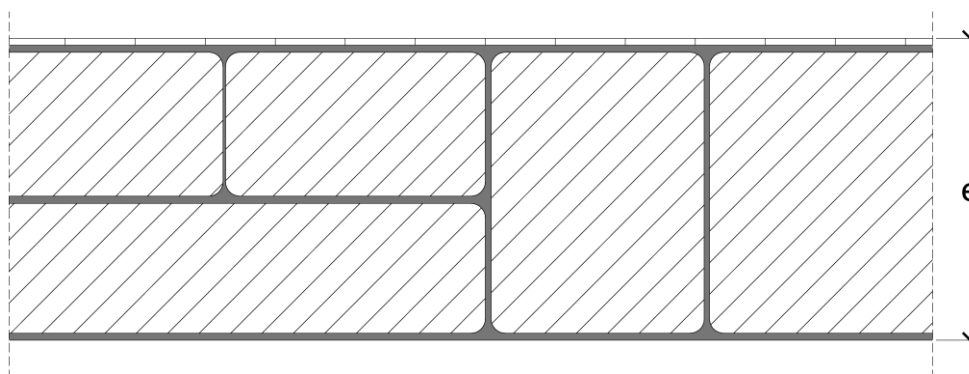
Esquema construtivo tipo da parte opaca do elemento fachada.
